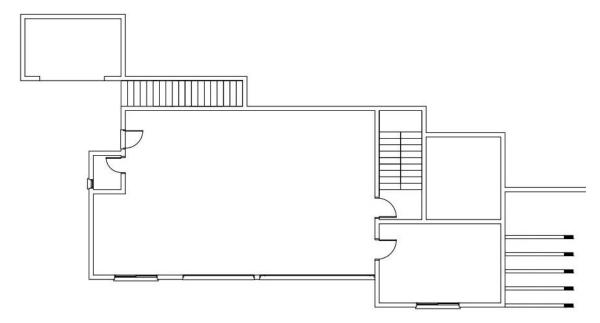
Planta baixa Pavimento inferior Fonte: Projeto Arquitetônico (2017).
